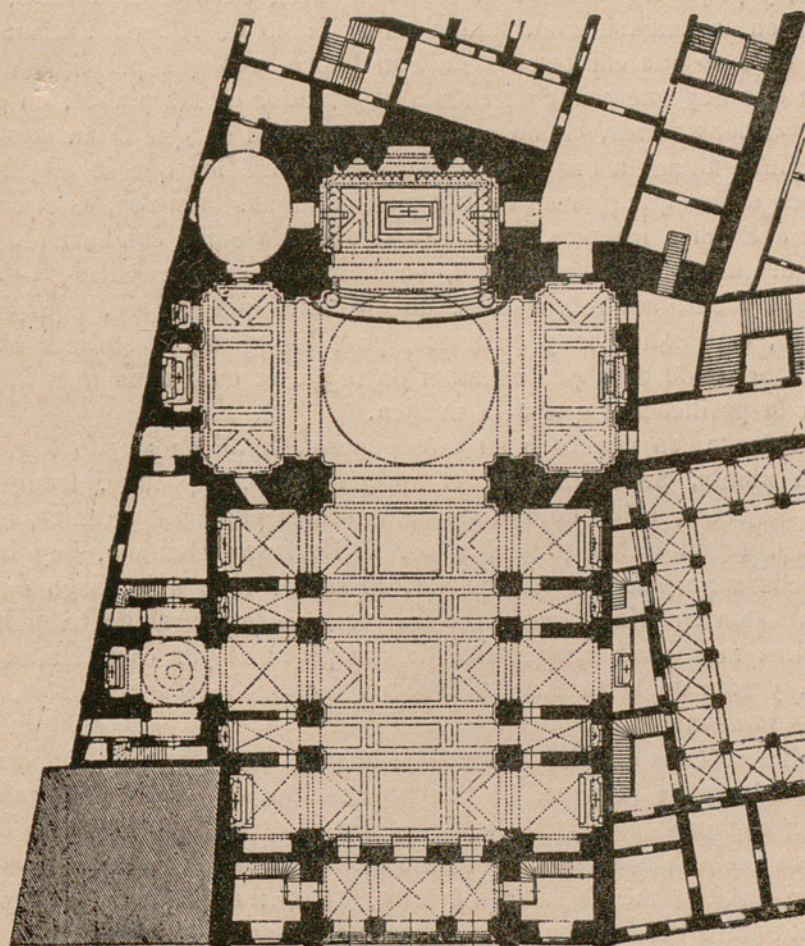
Planta de la Catedral de Madrid. (O. Schubert.)
